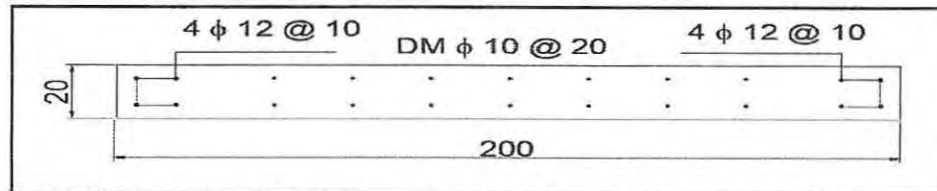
Armadura de flexo-compresión Muro 2, Estructura II (Aislada).
